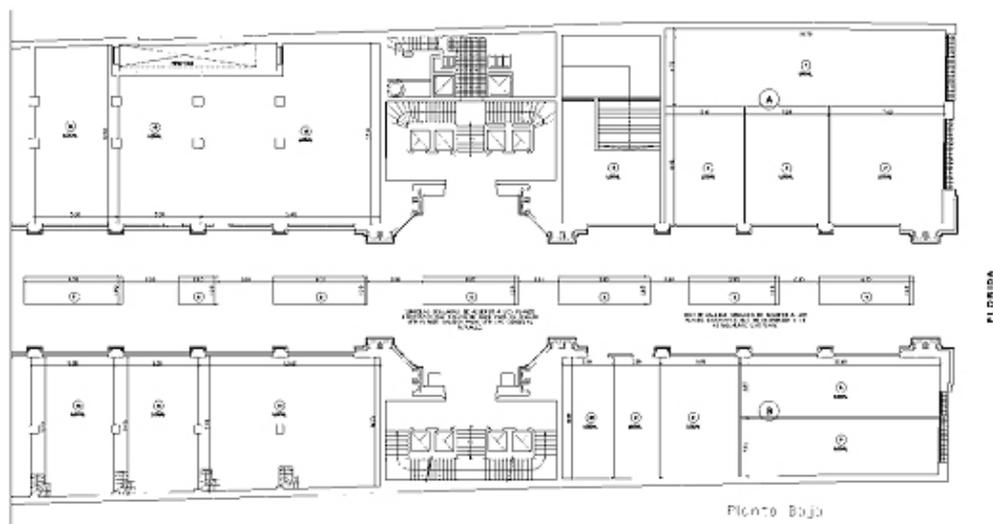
Planta baja del edificio de la Galería Güemes. (Lemos)
